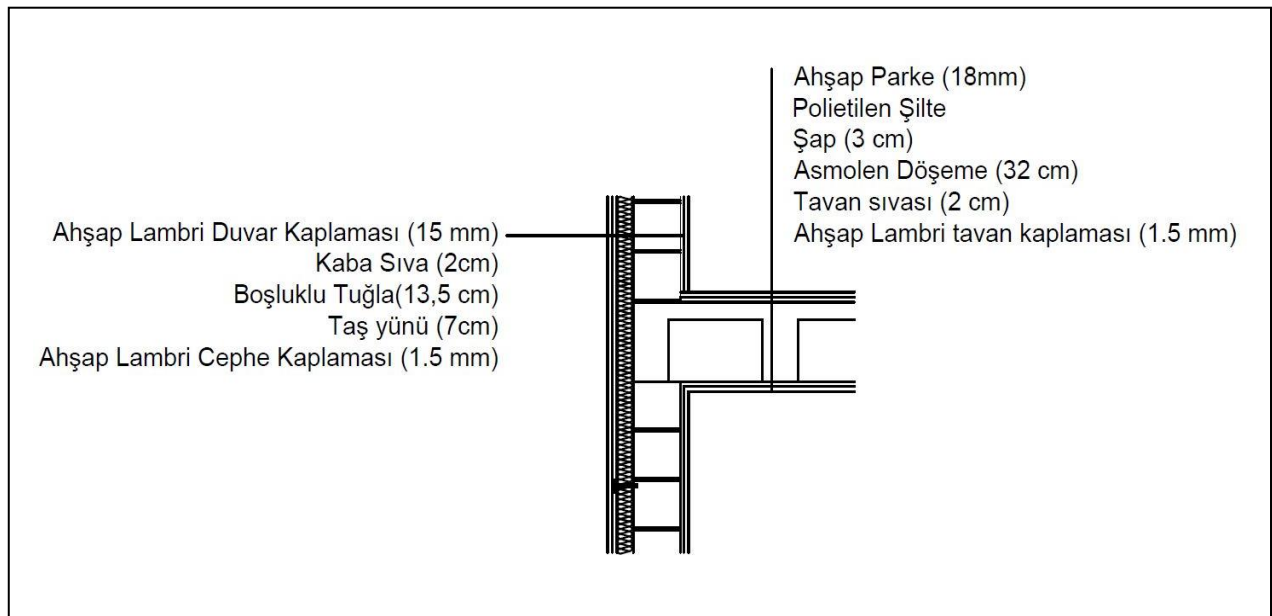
Betonarme-1 alternatifi kesitleri
